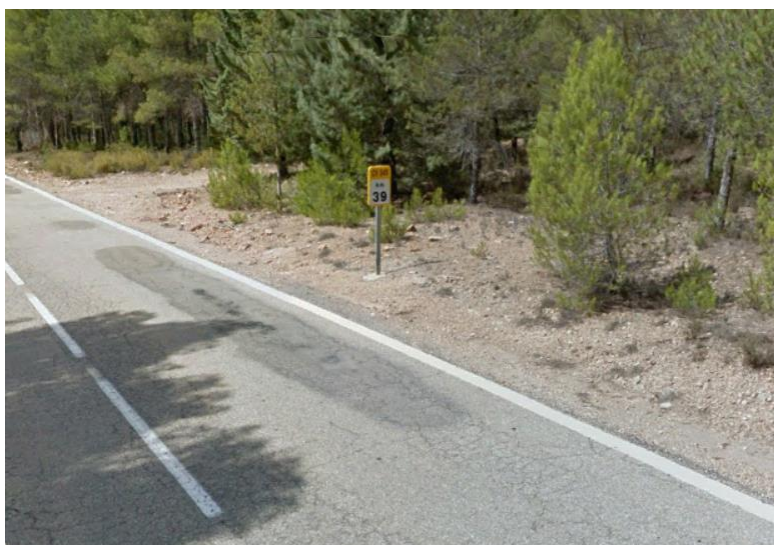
Estado actual de la sección transversal de la carretera P.K. 39+000 (Fuente: Salida de campo)
